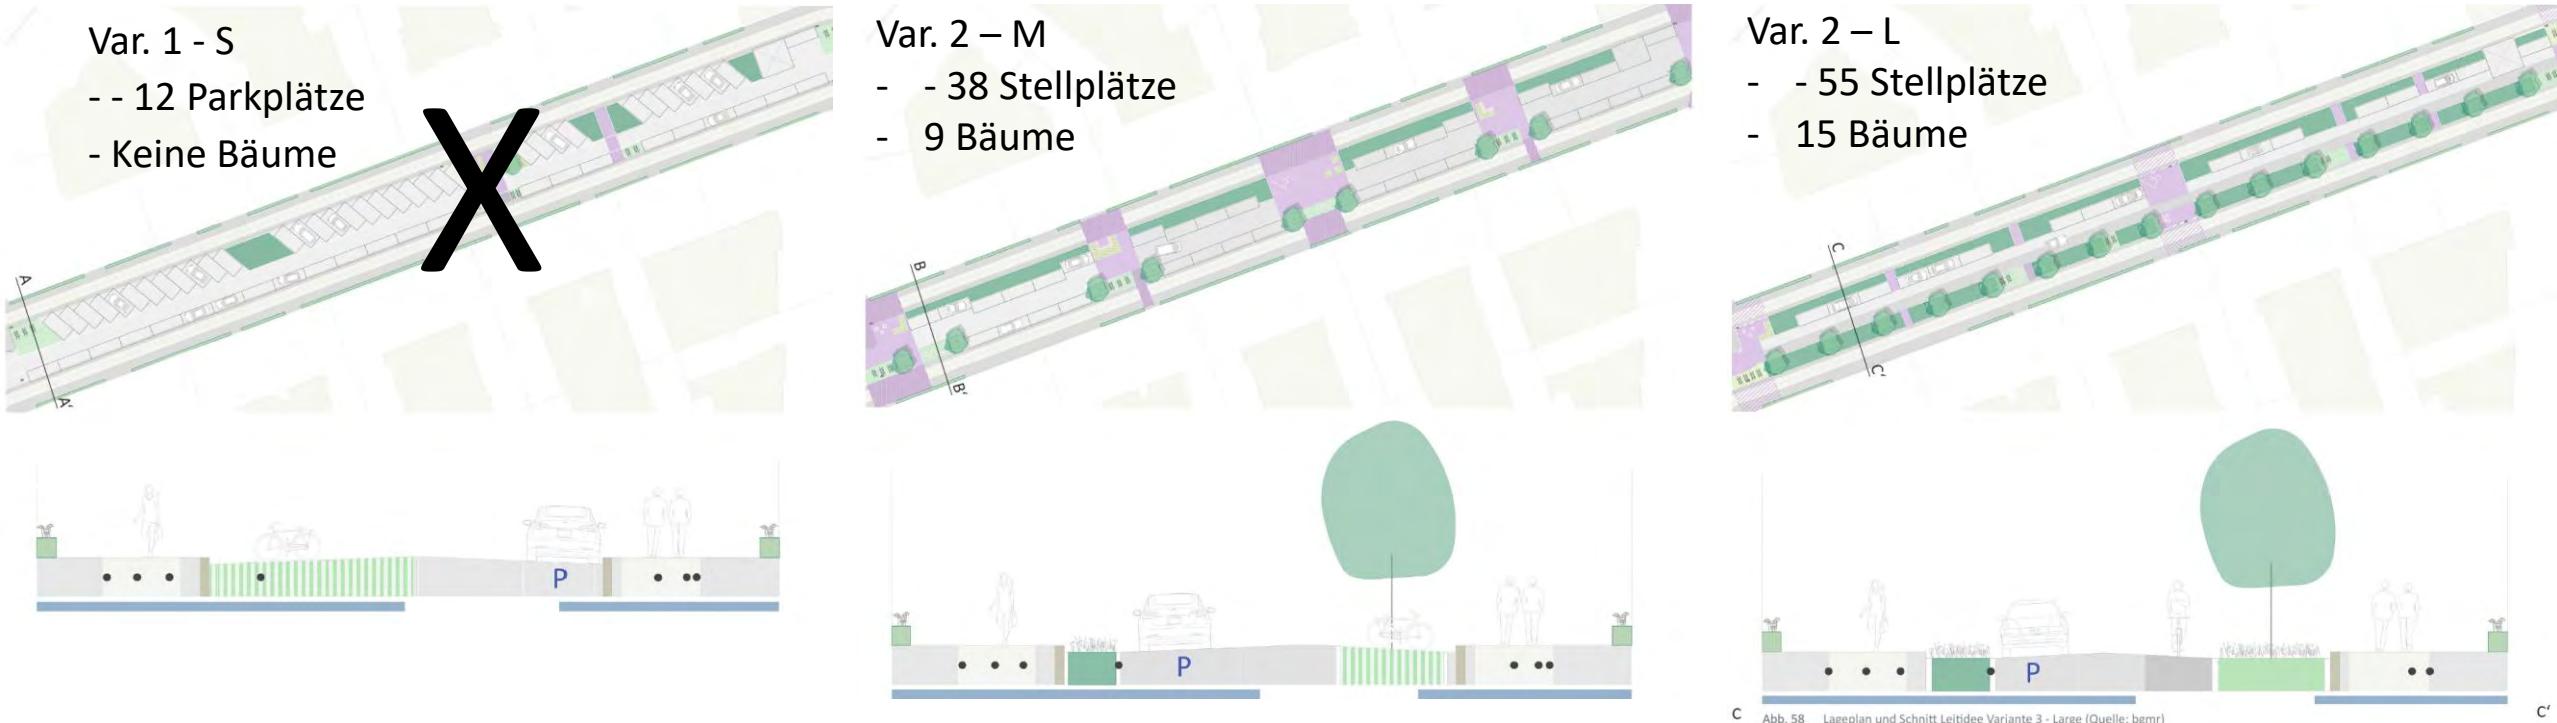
Lageplan und Schnitt Leitidee Variante 3 - Large (Quelle: bgmr)
